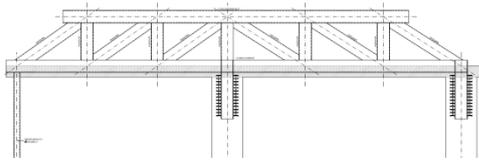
Cerchas metálicas encargadas de recoger los tirantes metálicos.
